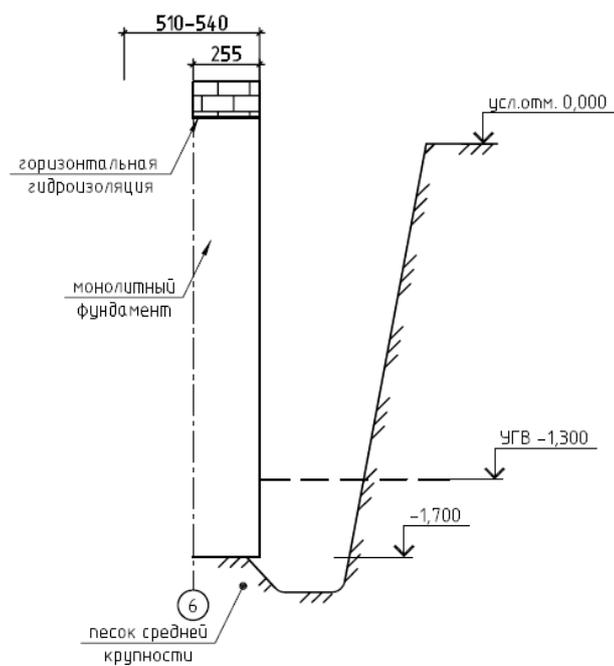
Конструкция фундамента в шурфе №1.
